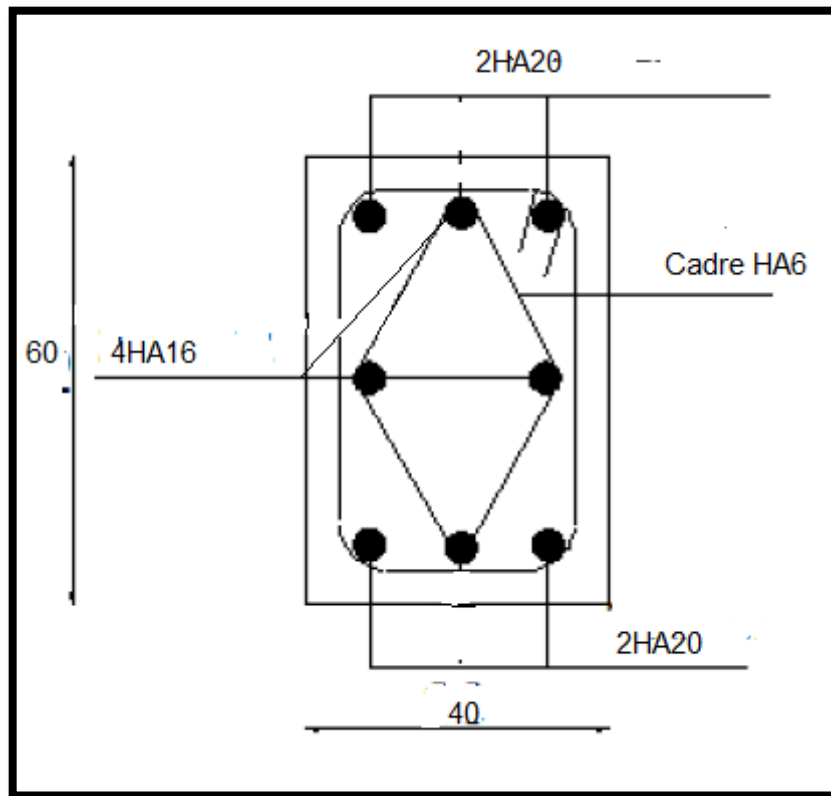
Schéma de ferrailage de poteaux (40\*60).
